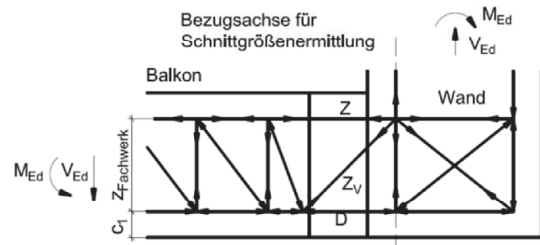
Schöck Isokorb® Typ K-U und K-U-F mit Anschluss an Wand
